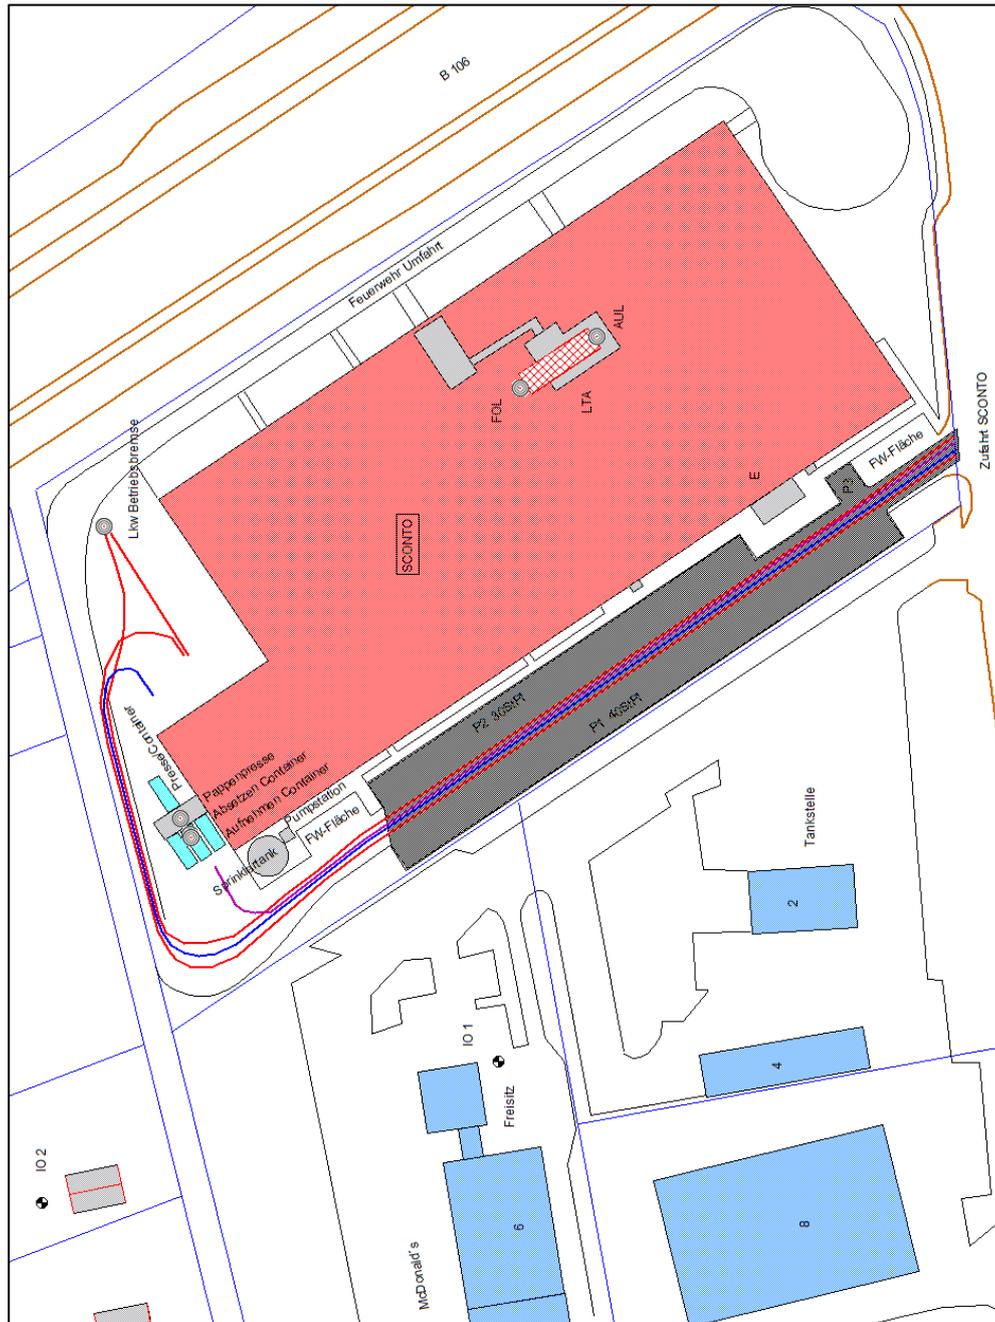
Ausschnitt des Lageplanes (Ausschnitt Abbildung 5) mit Flächenschallquelle FSQ Parkplatz, Lieferzufahrten und lufttechnischer Anlage auf dem Dach des Marktes
